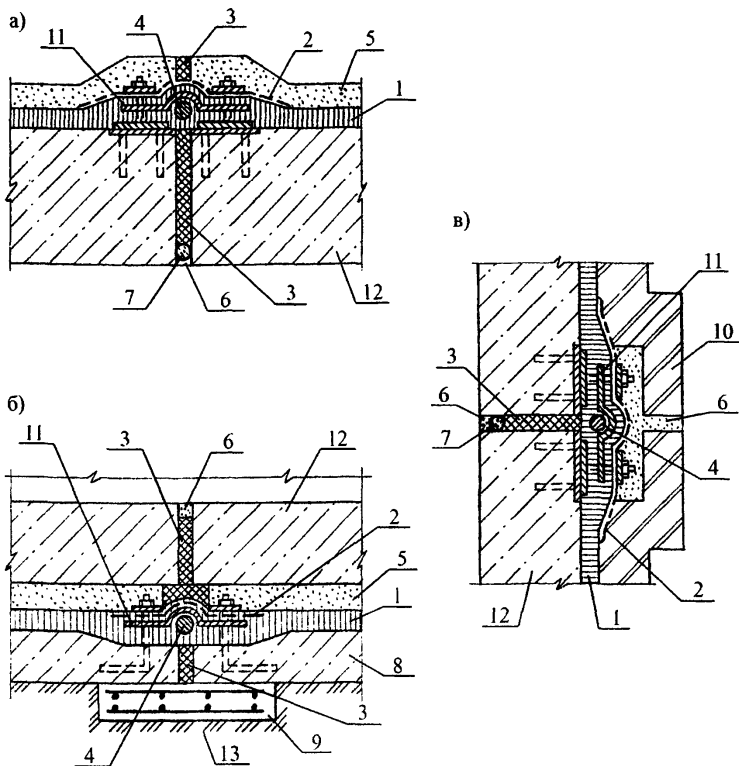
Гидроизоляция деформационного шва в штукатурной гидроизоляции
